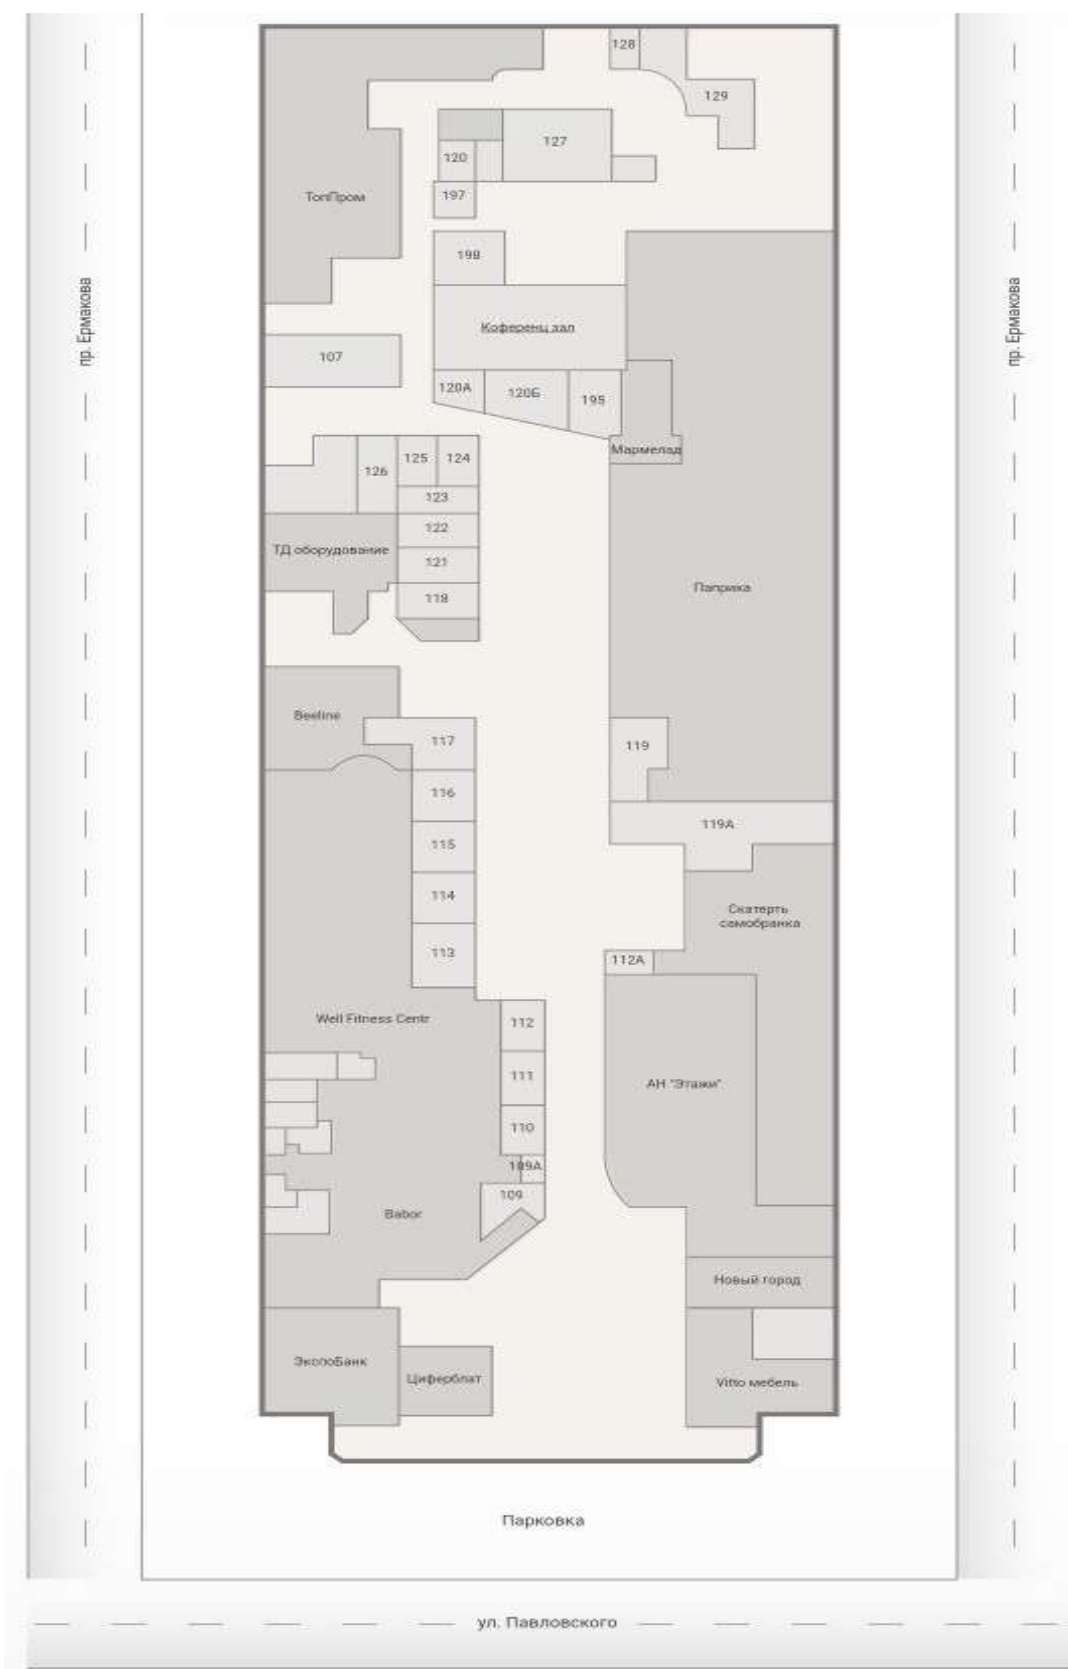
План первого этажа БЦ «Сити»
